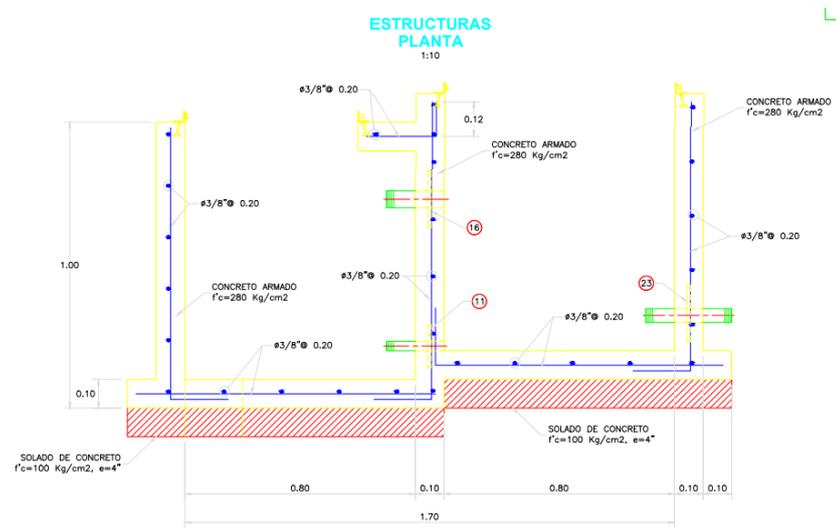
plano de estructuras, cámara rompe presión tipo 6
